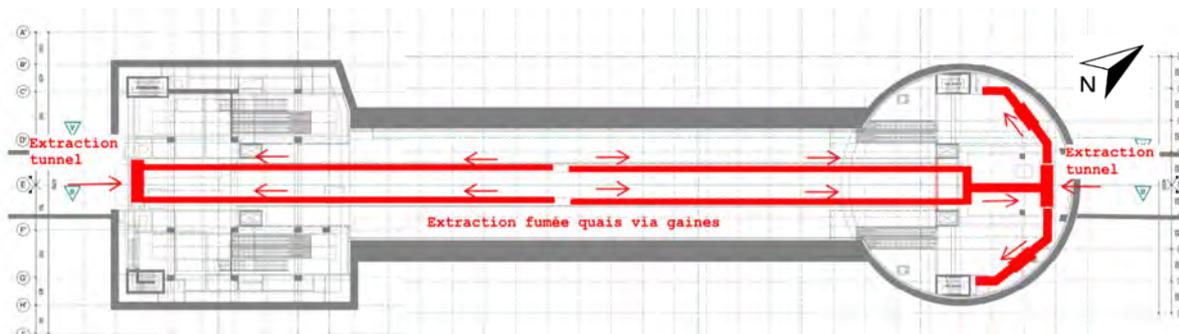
Plan de principe d'extraction des fumées – Niveau +2,25 m (BMN, 2018)
